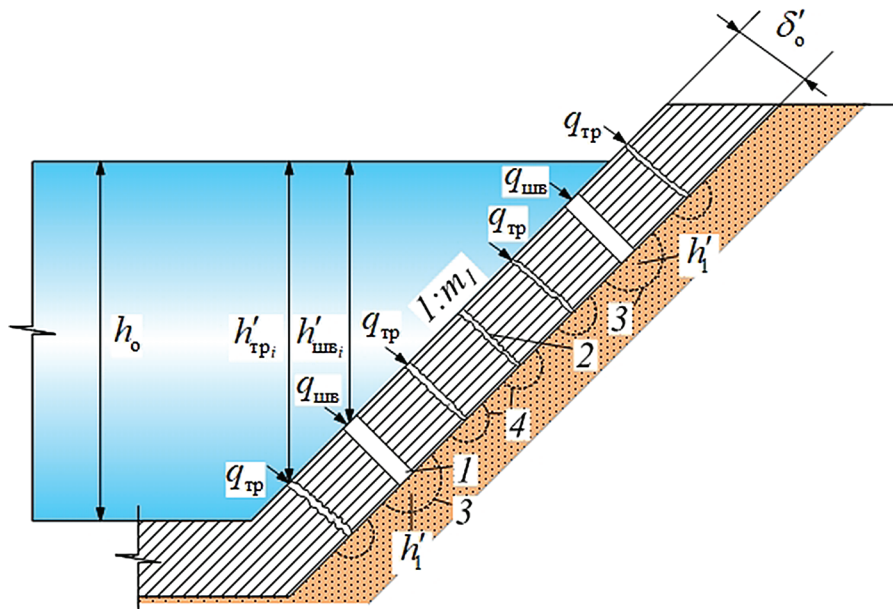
Расчетная схема водопроницаемости бетонной облицовки на откосе канала при длительной его эксплуатации:
